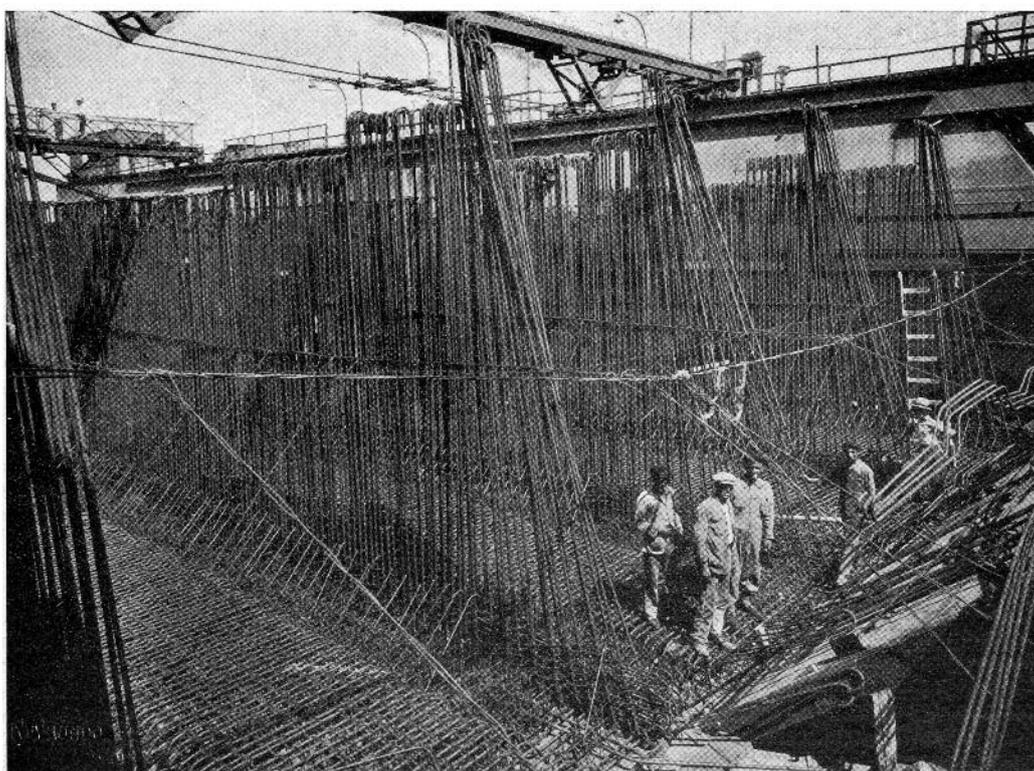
Armaduras de los mamparos del cajón, que son vigas cuadernas de la solera del dique, para su trabajo definitivo
